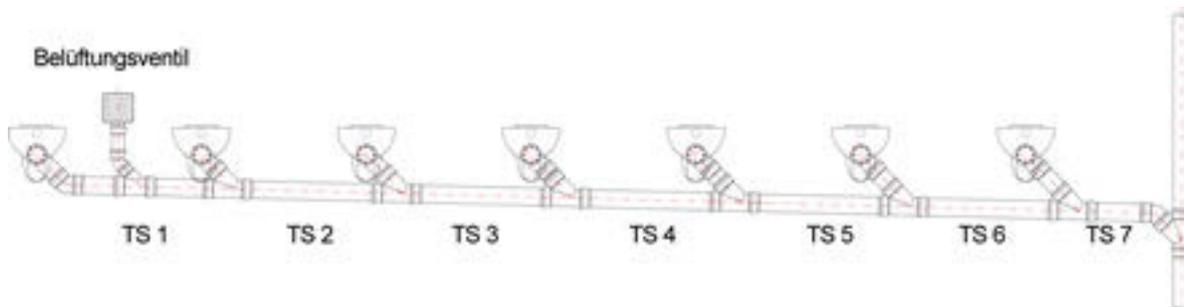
hochbelastete Sammelanschluss-/Sammelleitung (Reihen-Klosettanlage) mit öffentlicher Nutzung
